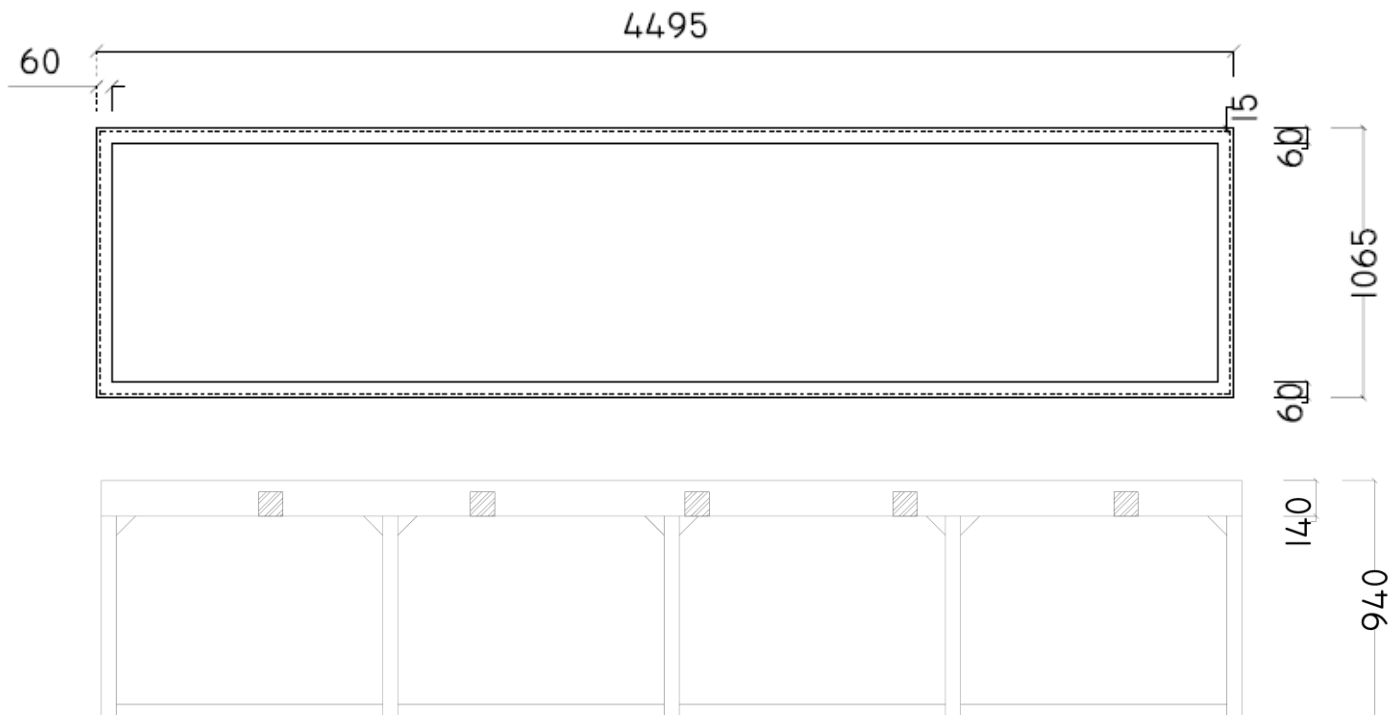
Essiccatoio. Schema planimetrico e prospetto principale.
